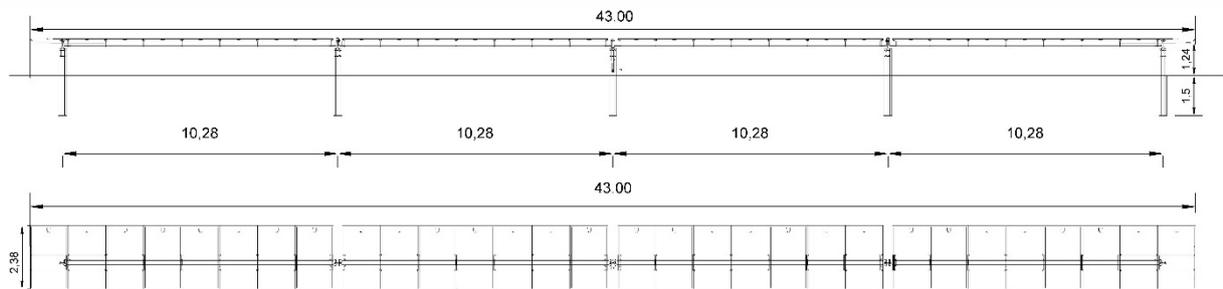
Prospecto frontale e vista in pianta delle strutture (30 moduli) ad inclinazione 0°
